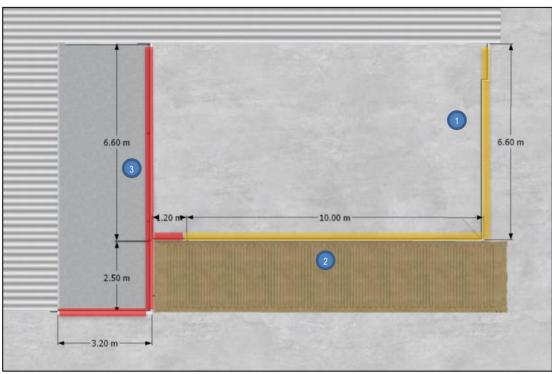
Vista en planta de emplazamiento de pantalla acústica.
